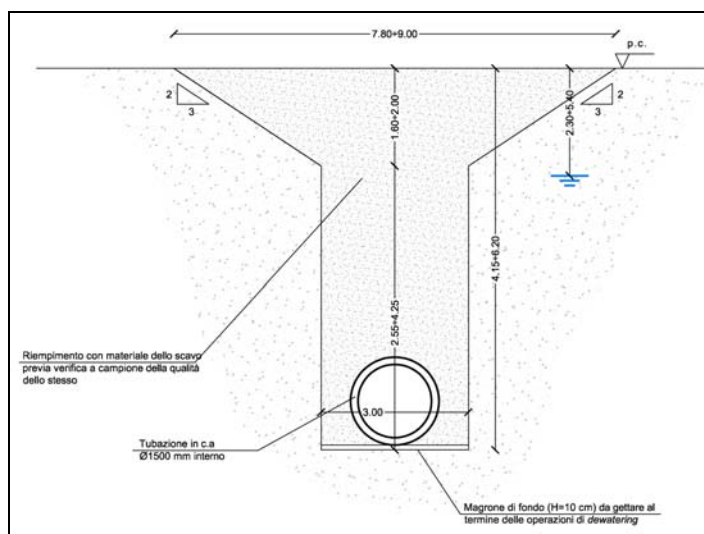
Sezione dreno in tratto non coincidente con il T. Marmazza
